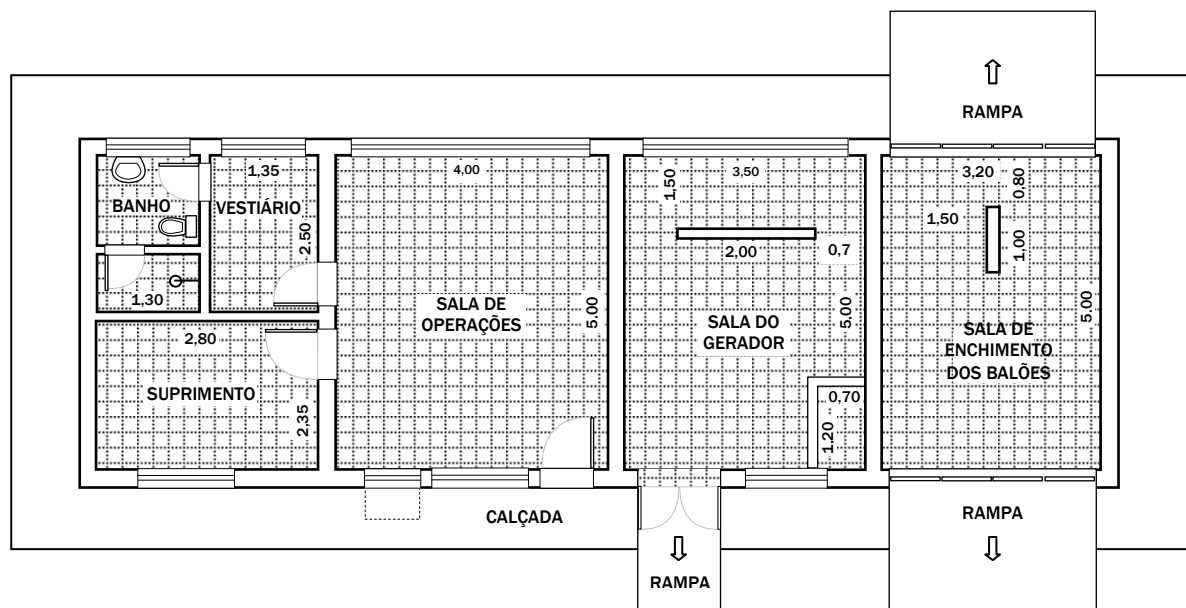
Sugestão de planta baixa para o prédio da EMA
